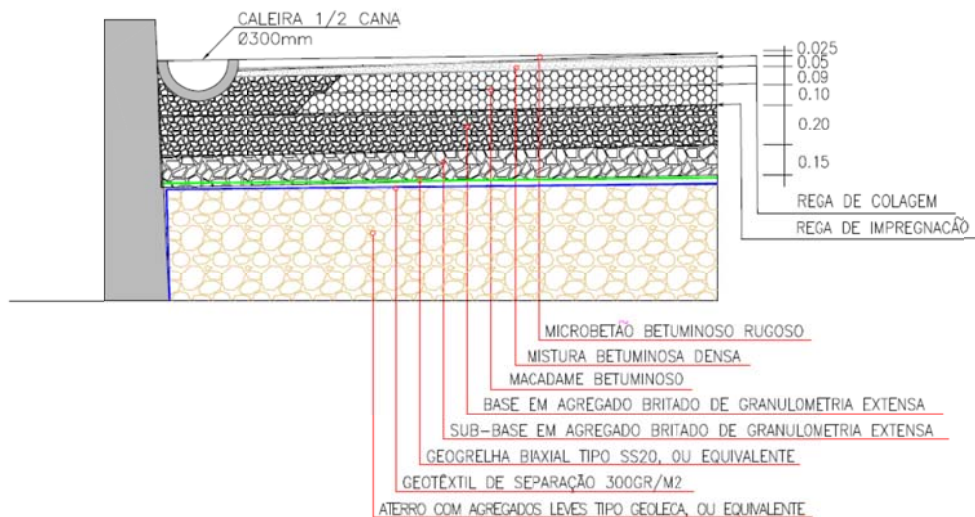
Corte transversal (ilustração) do pavimento aplicado.
